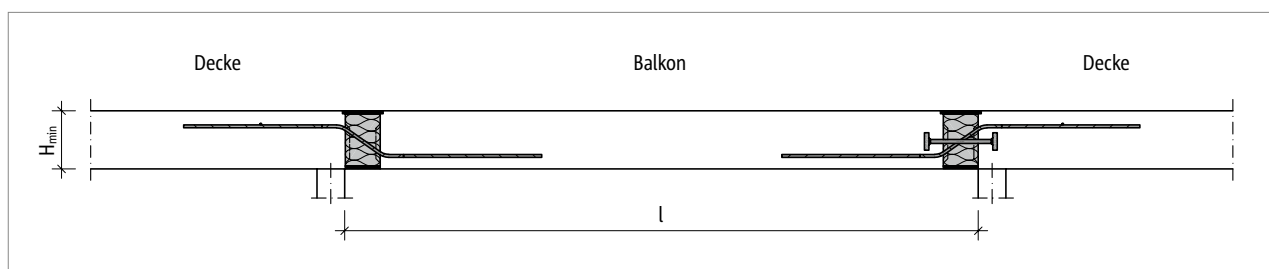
Schöck Isokorb® XT Typ QP-Z, QP: Statisches System
